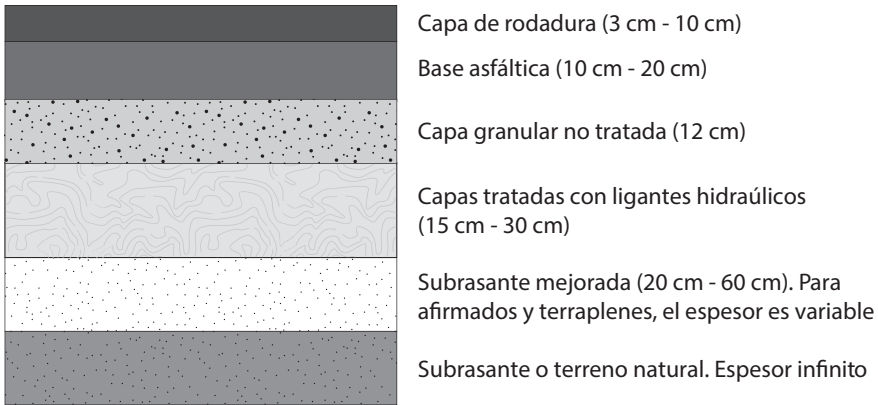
Figura D. Perfil típico de una estructura de pavimento con estructura mixta
